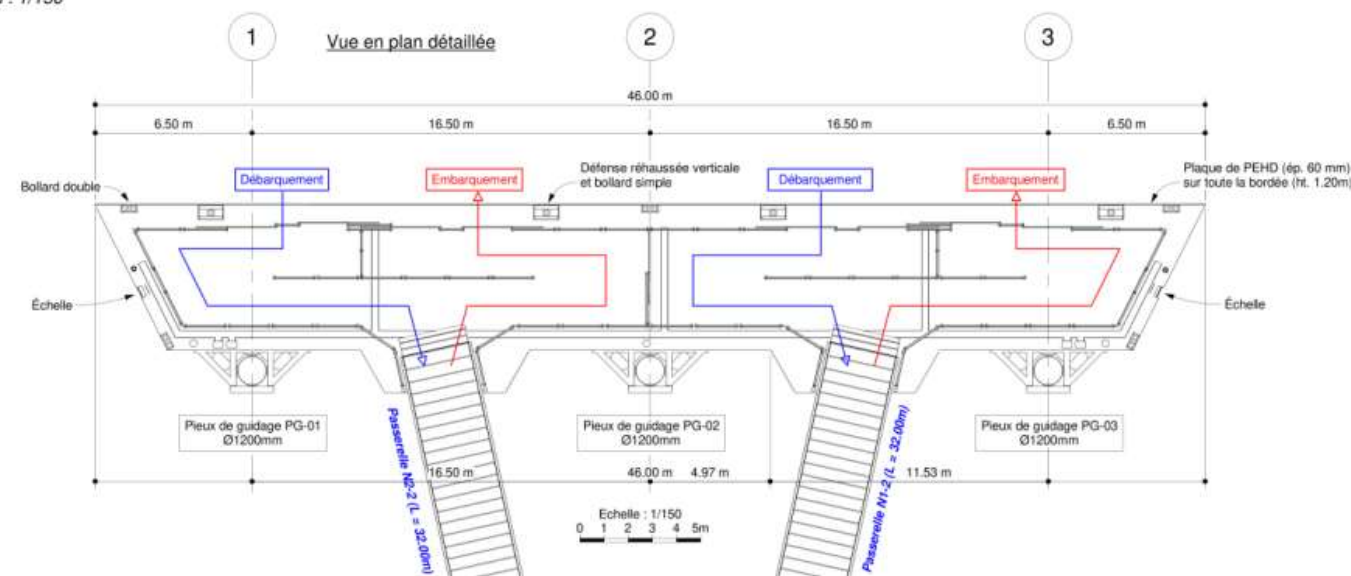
Plan du ponton d'amarrage (SCE, décembre 2023)
